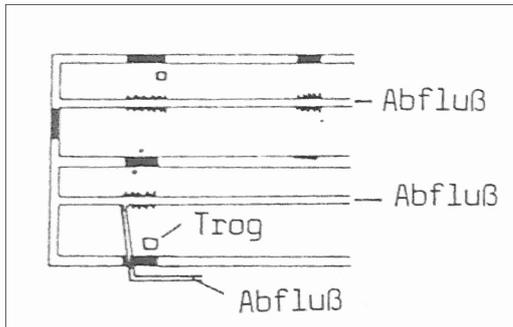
Ilkley, GB. Stallgebäude mit Jaucherrinnen
